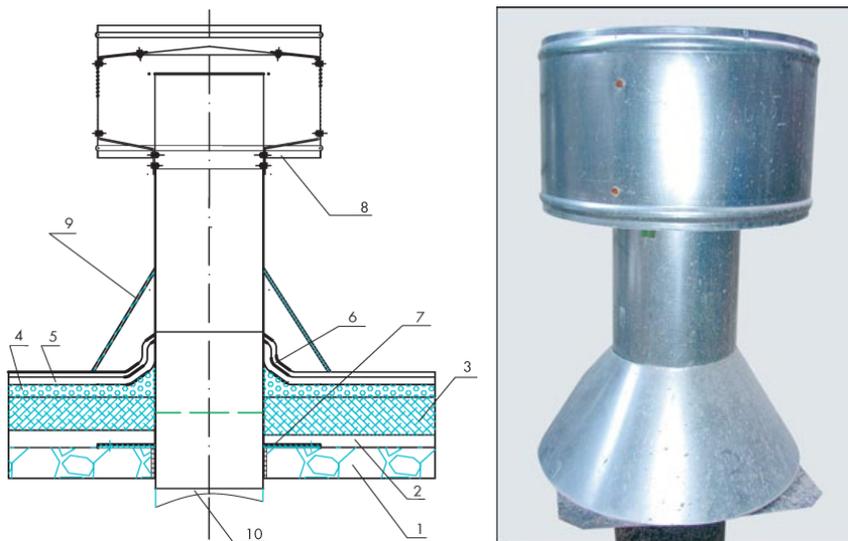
Схема вентиляційного вузла сміттєпроводу:
